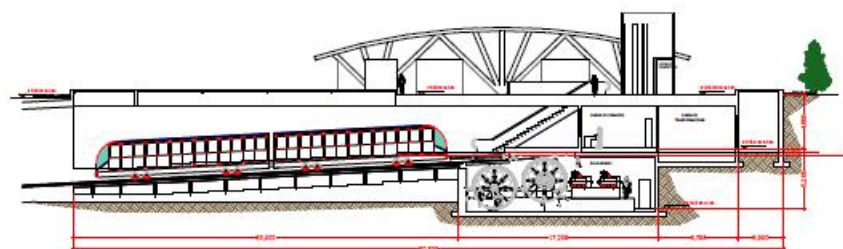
Sezione in asse impianto - stazione "Parco Erzelli"
